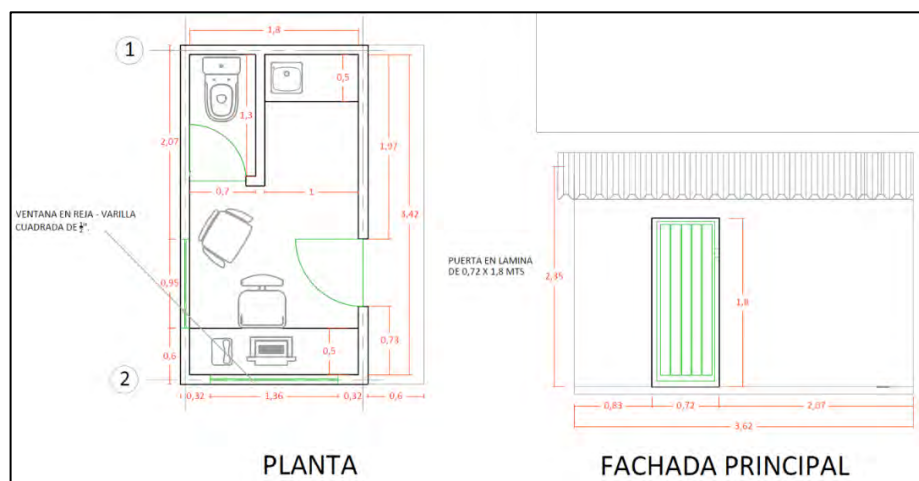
Planta arquitectónica y fachada principal de la caseta de vigilancia
